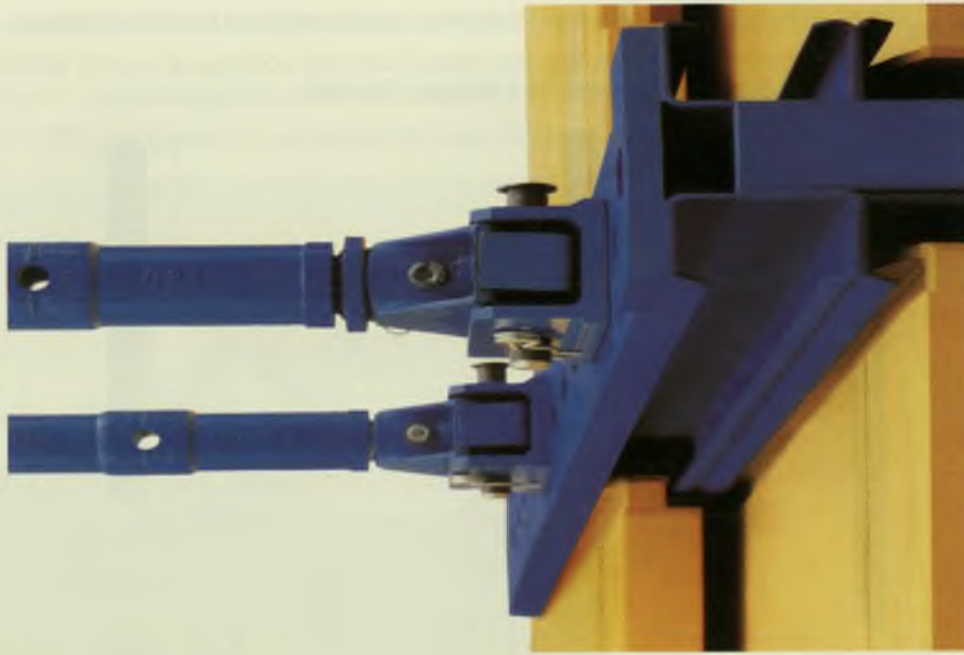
Detalle de planchas deslizantes sobre doble guía
